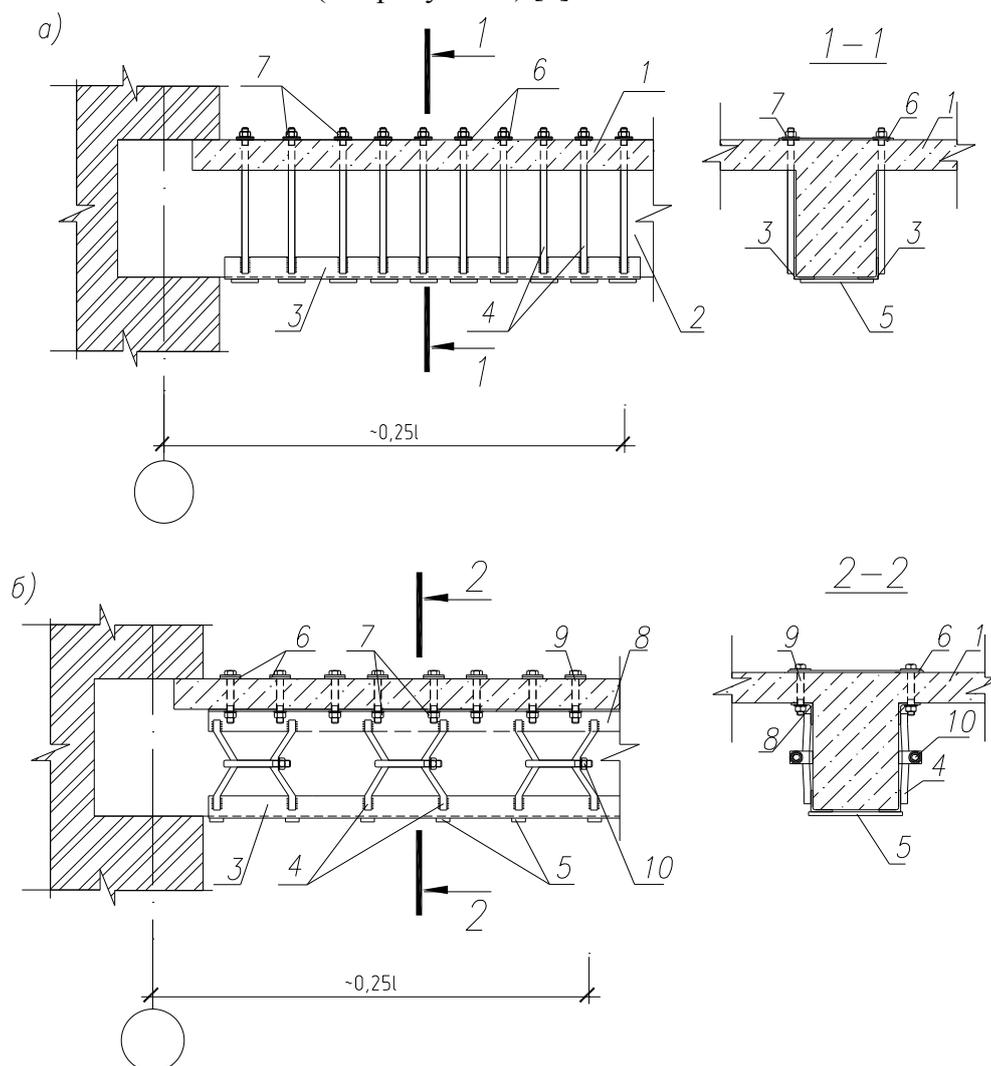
Схема усиления наклонных сечений железобетонных балок:
